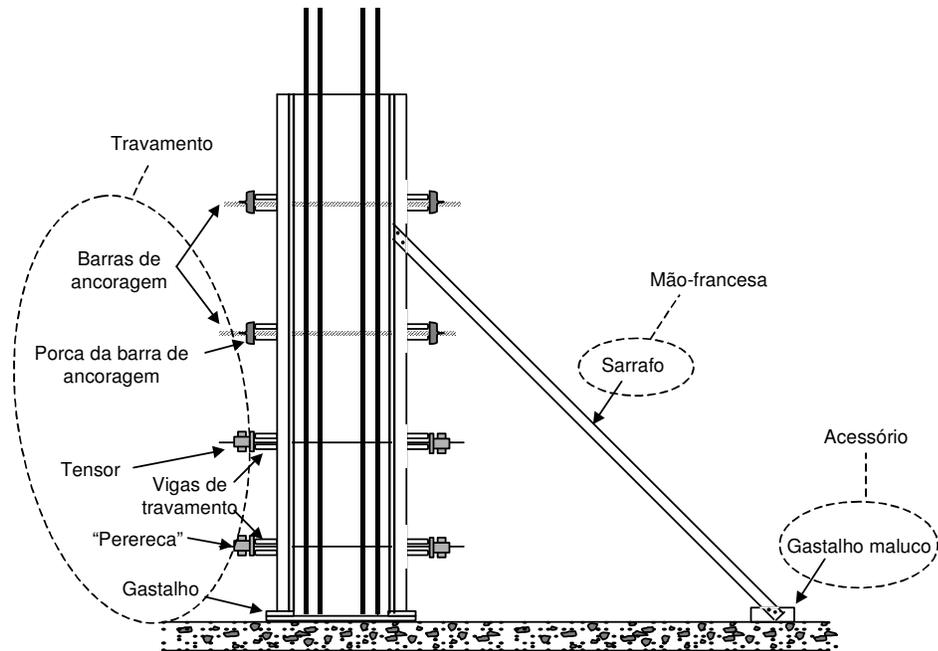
Corte do pilar com fôrma com travamento composto por vigas de travamento, barras de ancoragem e tensores e mão-francesa com sarrafo.
